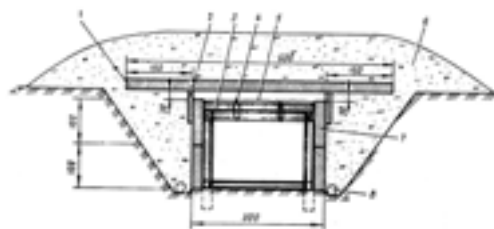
Быстровозводимое убежище податливой конструкции из панелей перекрытия типа ПК: 1 – железобетонная панель перекрытия типа ПК; 2 – деревянный щит; 3 – деревянная распорная рама; 4 – проволочная скрутка; 5 – гидроизоляция; 6 – насыпной грунт; 7 – стеновая плита типа ПК; 8 – дренаж
